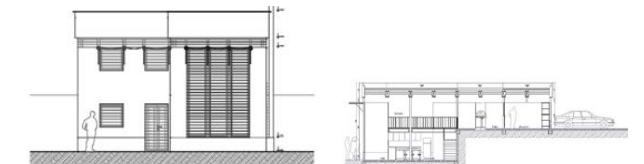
[Figura] Elevación y corte de casa Santander. Fuente: Bahareque construcciones
